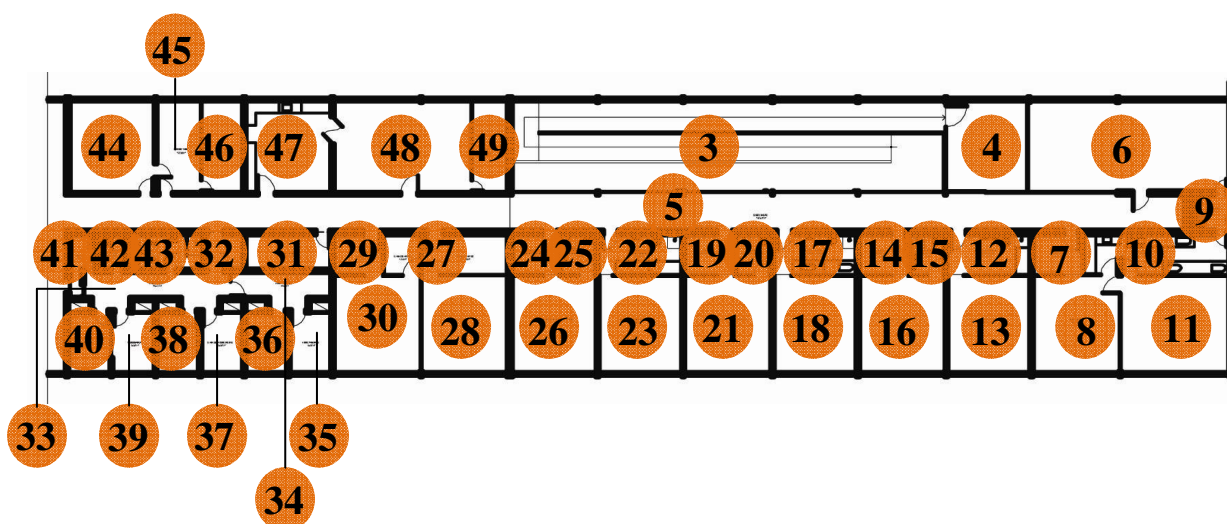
planta baixa segundo pavimento, referenciando os espaços indicados no quadro de áreas.
